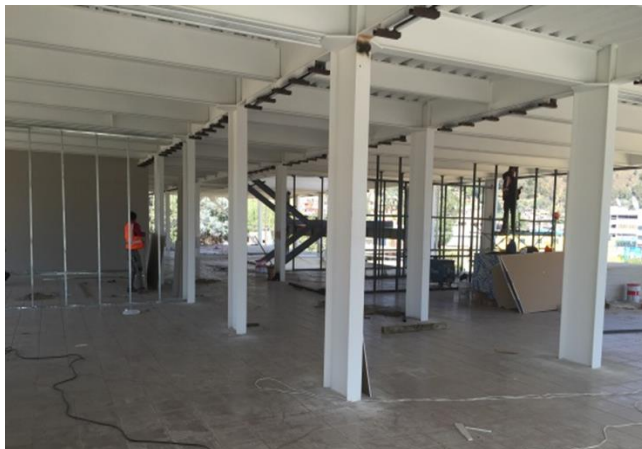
Preparación de instalaciones eléctricas en planta baja
